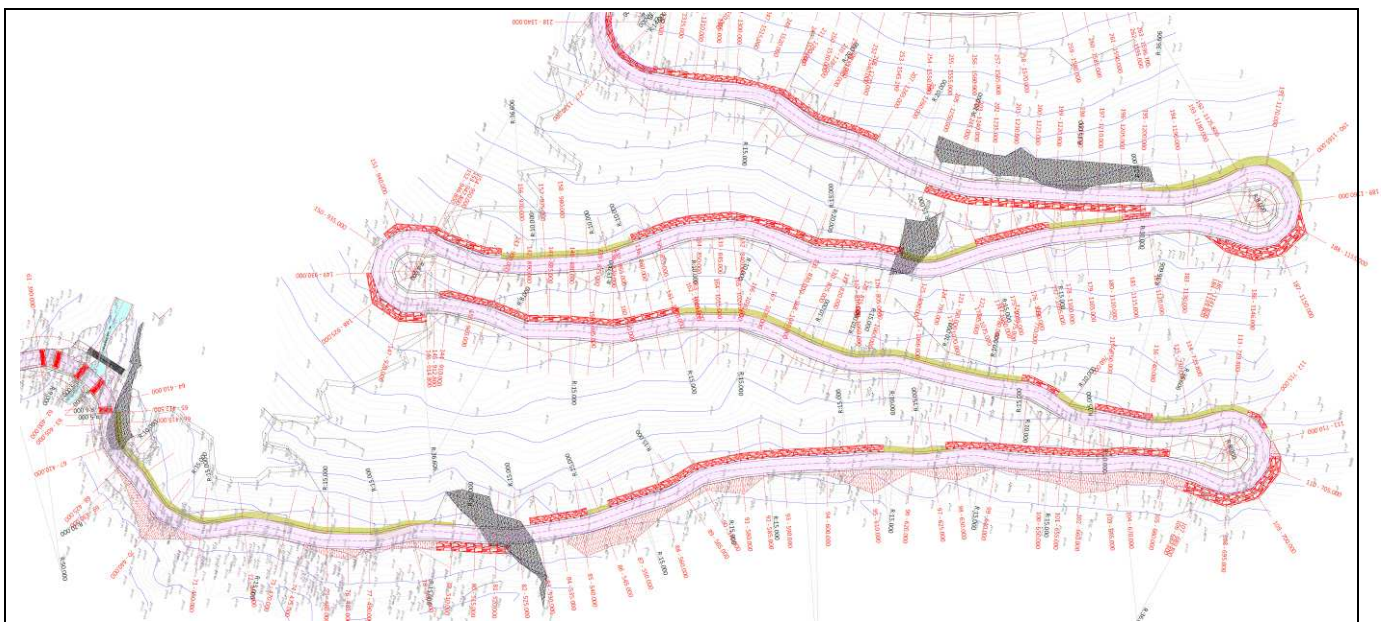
estratto planimetrico tratto a tornanti [tavola B3 Studio Maraffio]
